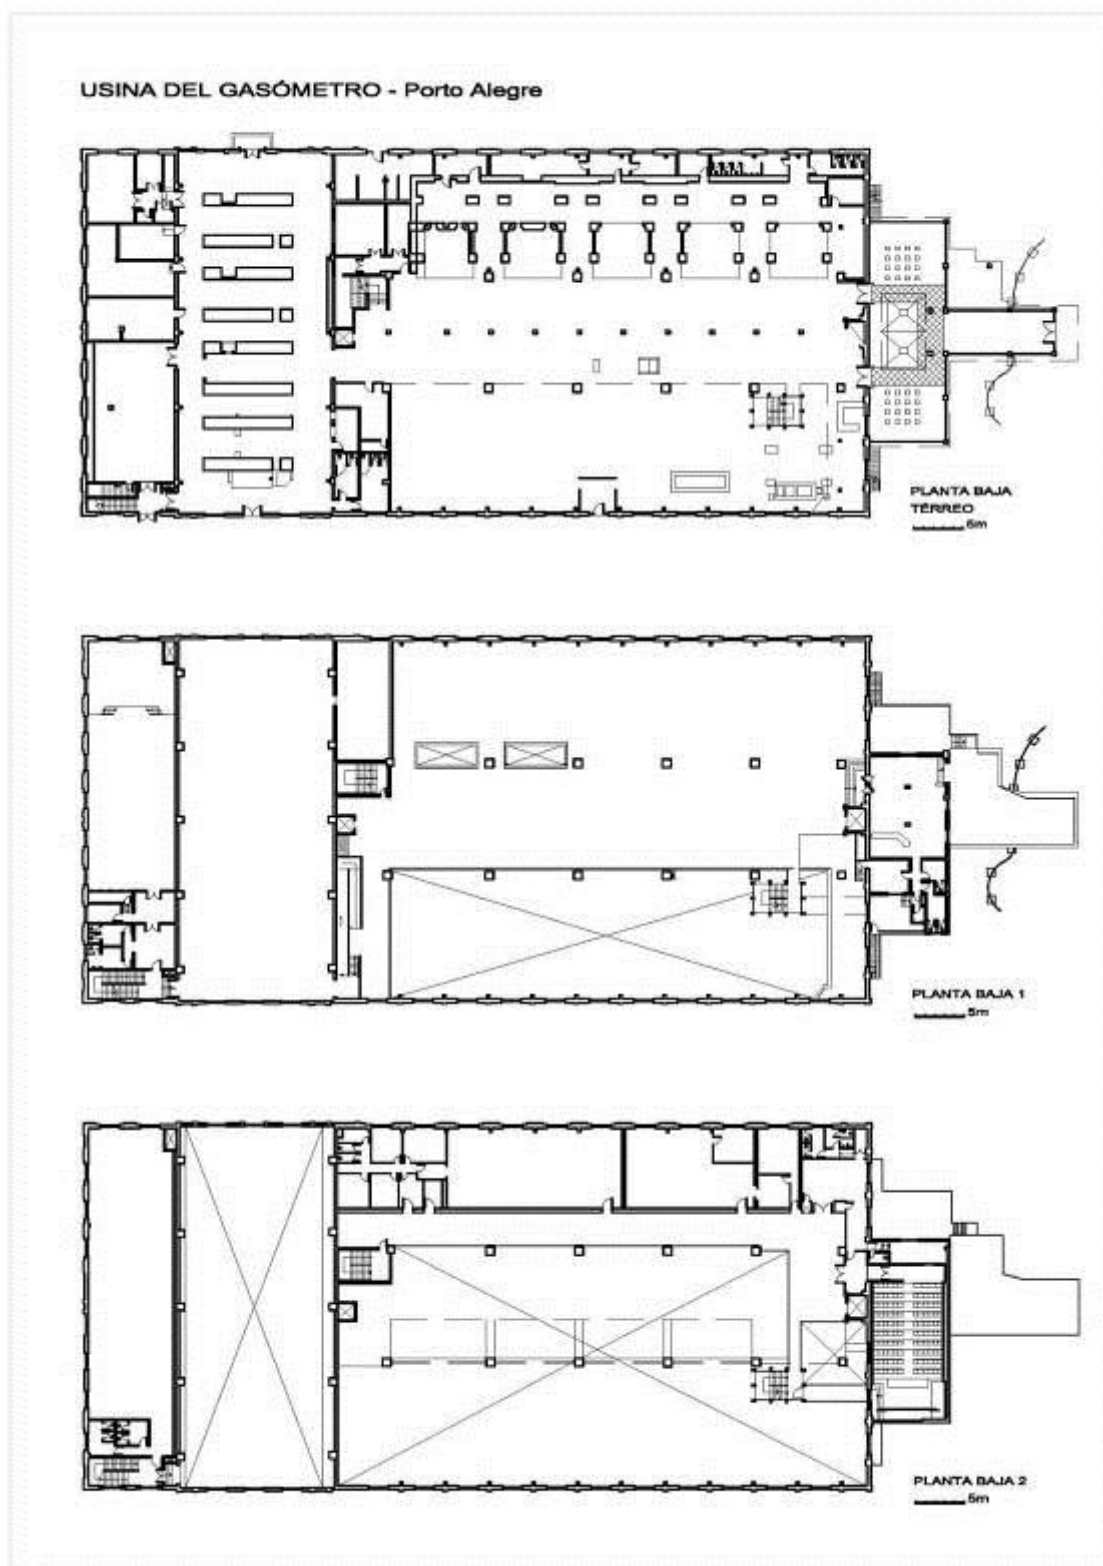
Usina del Gasómetro. Proyecto de restauración. Plantas Bajas, nivel de acceso, 1 y 2.
